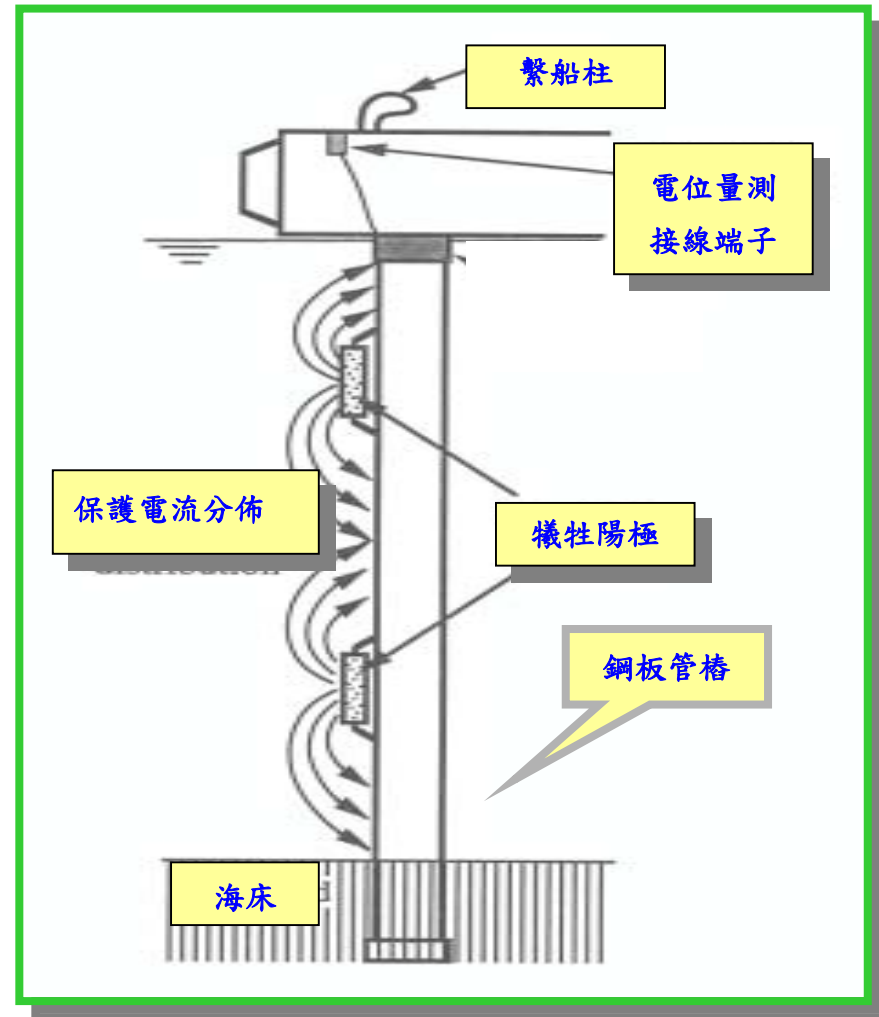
碼頭鋼板(管)樁犧牲陽極法示意圖
